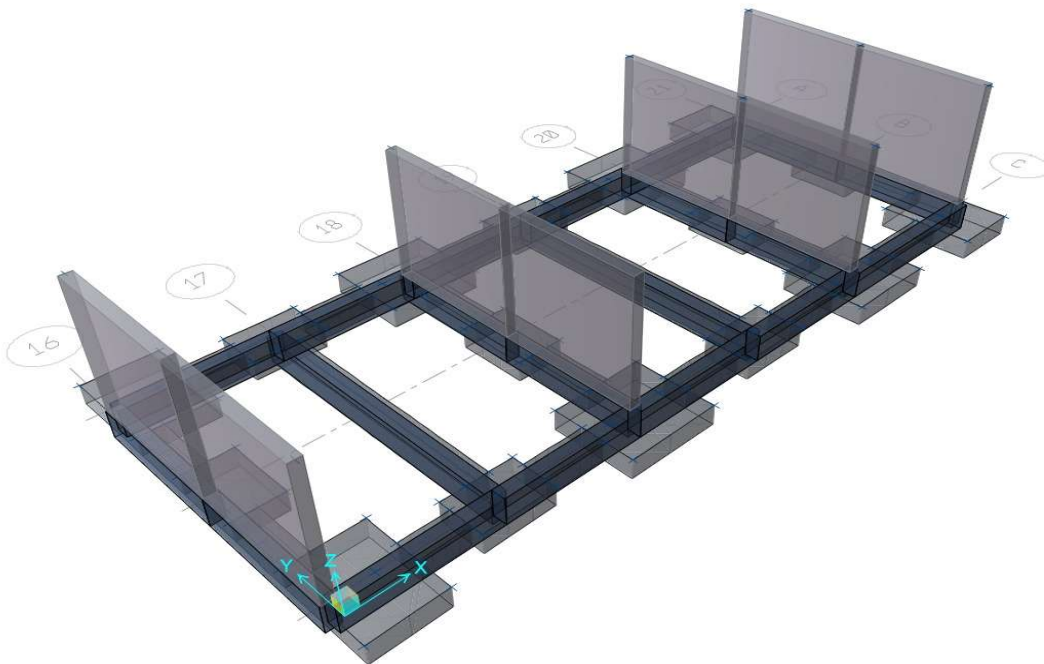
Modelado de cimentación de I.E N° 11526 Jesús Alfonso Tello Marchena.
